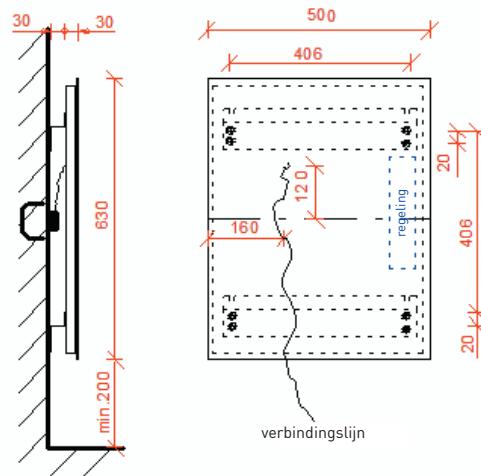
FIGUUR: BOORGATEN AFSTANDEN VOOR WAND OF PLAFOND MONTAGE
